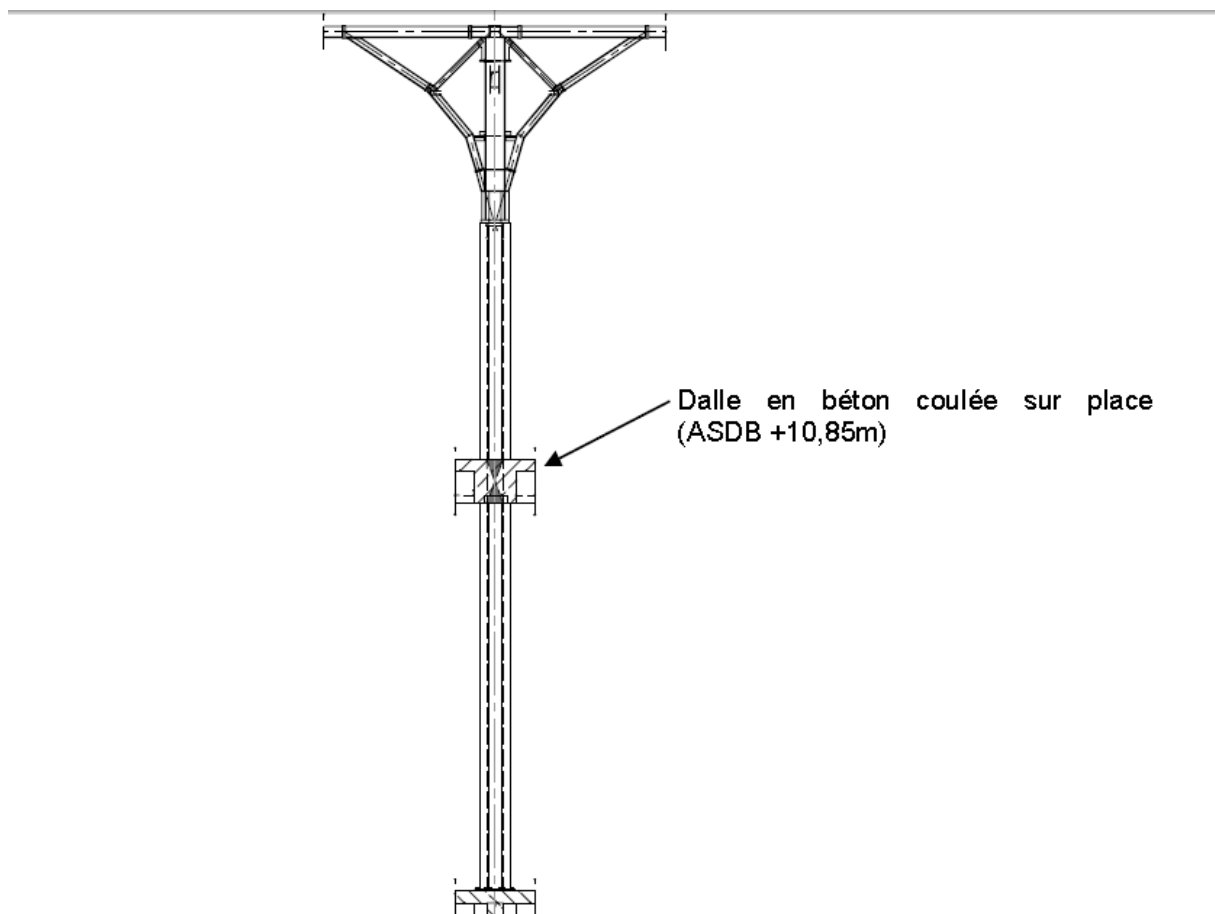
Structure d'un poteau de diamètre 81 cm – Type n° 1
